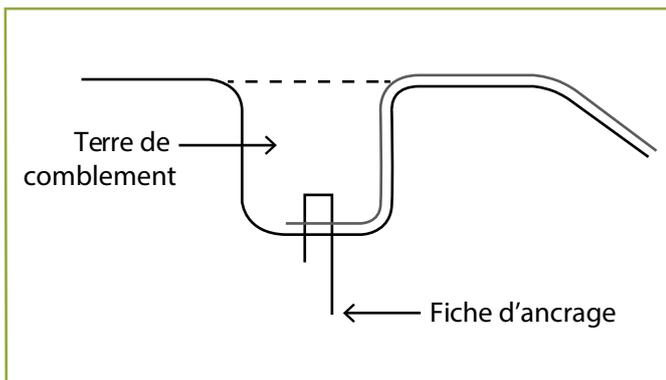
Schéma de finition du géotextile en crête d'ouvrage
